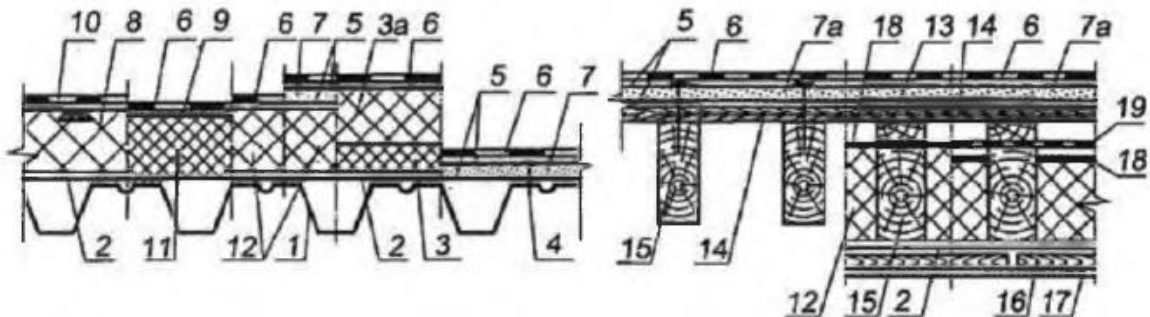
Технические решения конструкции покрытия скатных крыш (над мансардным этажом) с одним (а) и двумя воздушными зазорами над утеплителем
